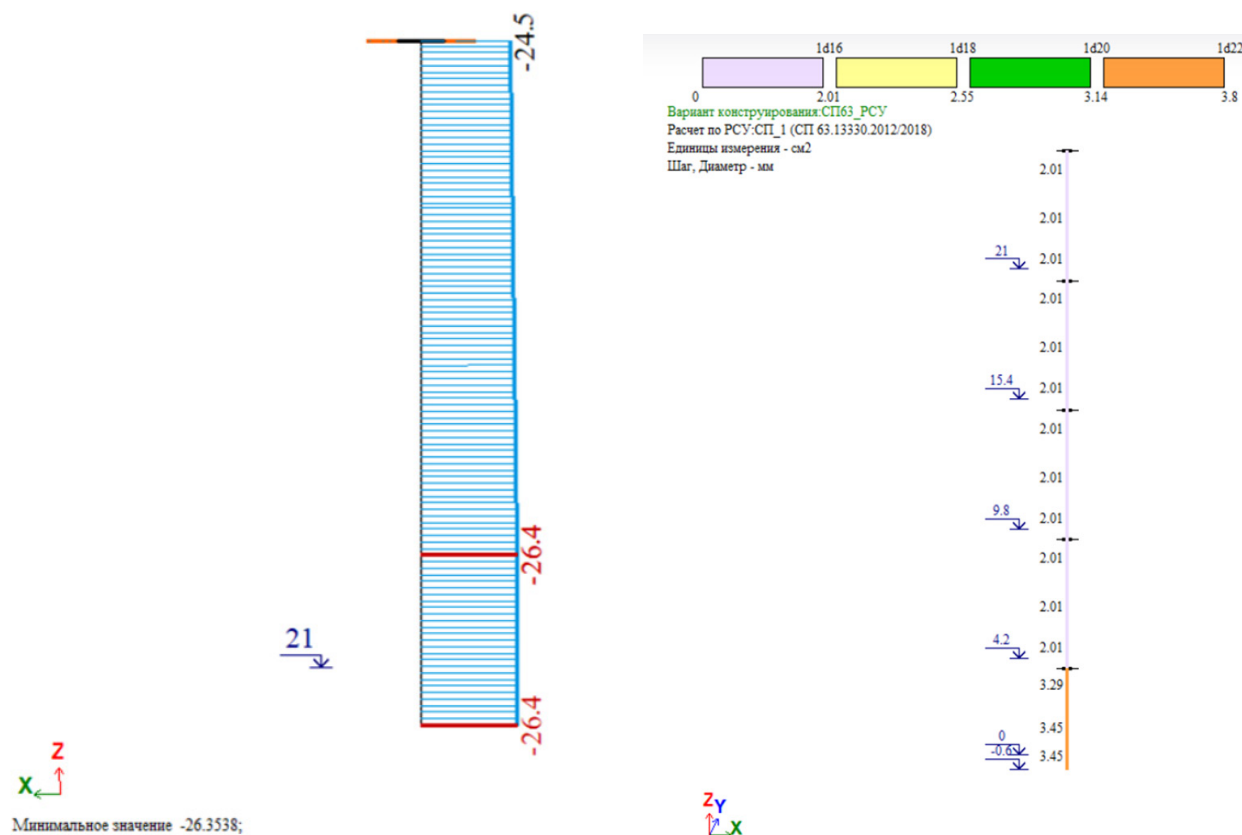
Эпюра продольных сил и подбор арматуры железобетонной колонны
